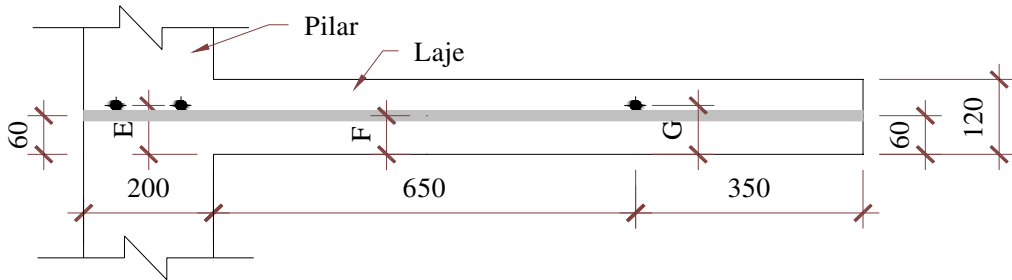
Disposição dos cabos de protensão para todas as lajes em planta (mm)
